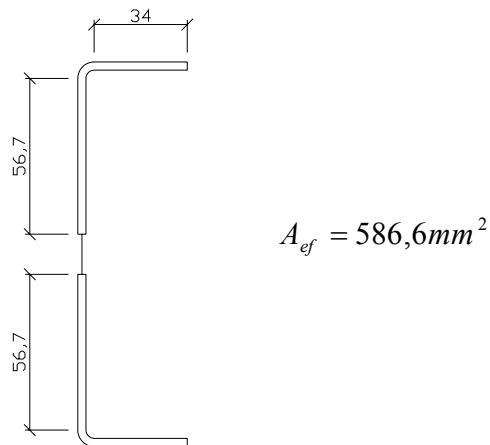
Secção efectiva do elemento de Contraventamento
